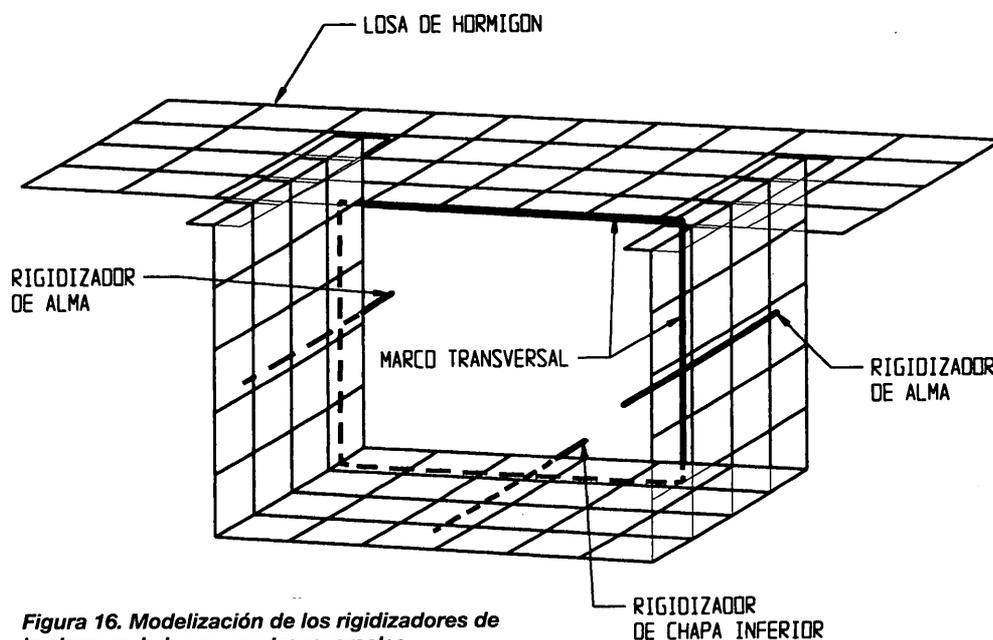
Modelización de los rigidizadores de la chapa y de los muros transversales.
